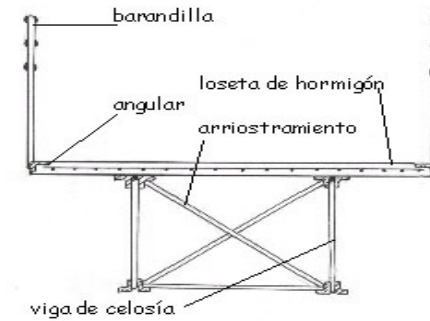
Sección transversal tipo. Ingrid Raventós (2000).
